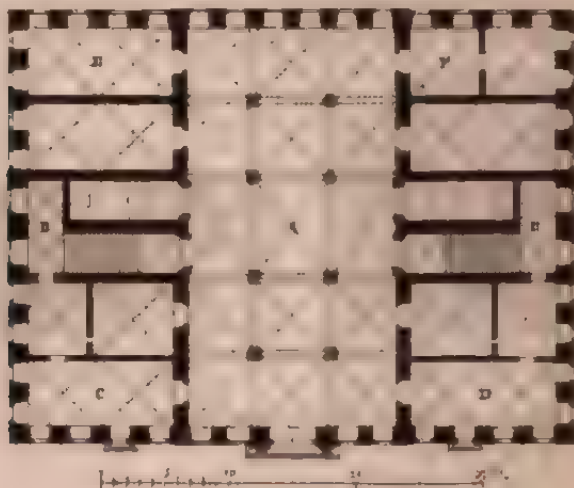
Rathaus zu Augsburg Erdgeschoss
